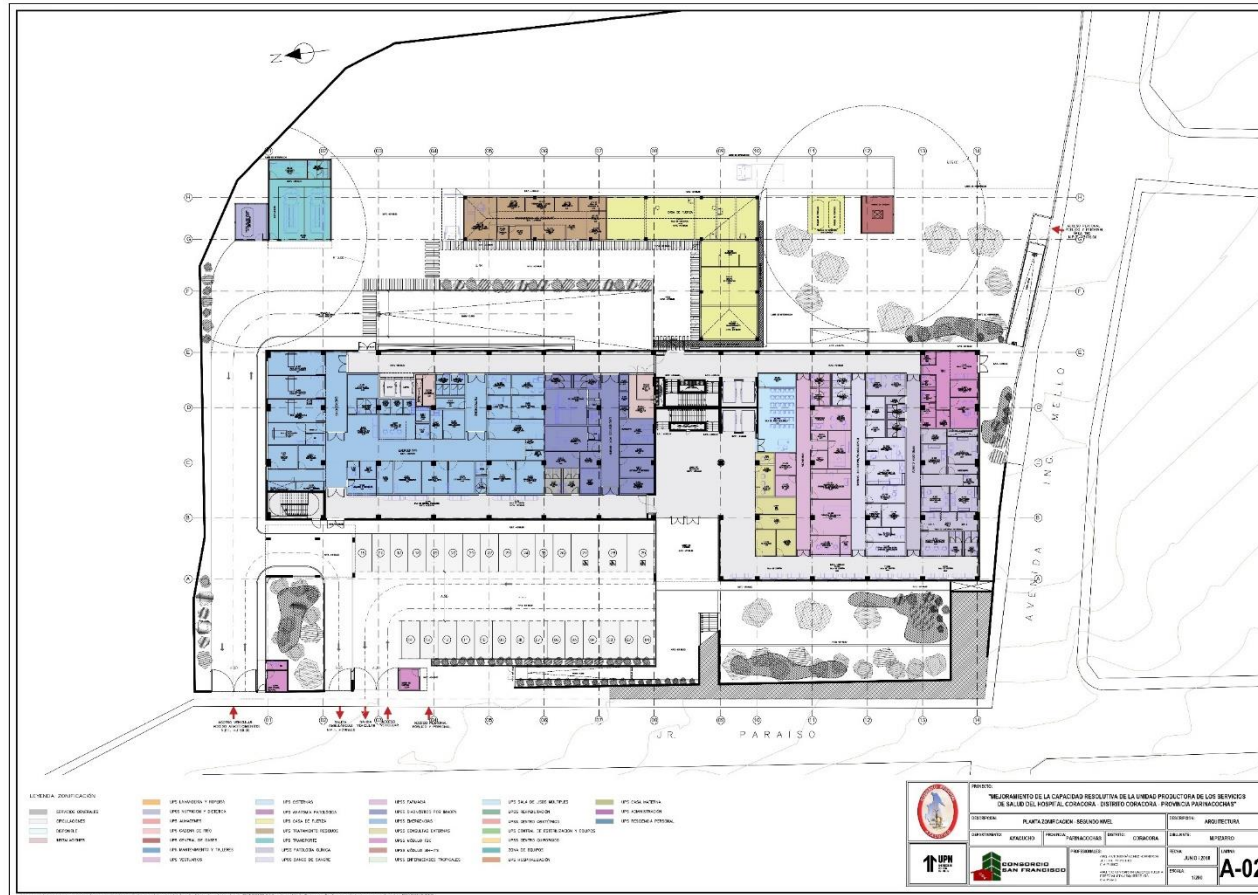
PRIMERA PLANTA ZONIFICACION
